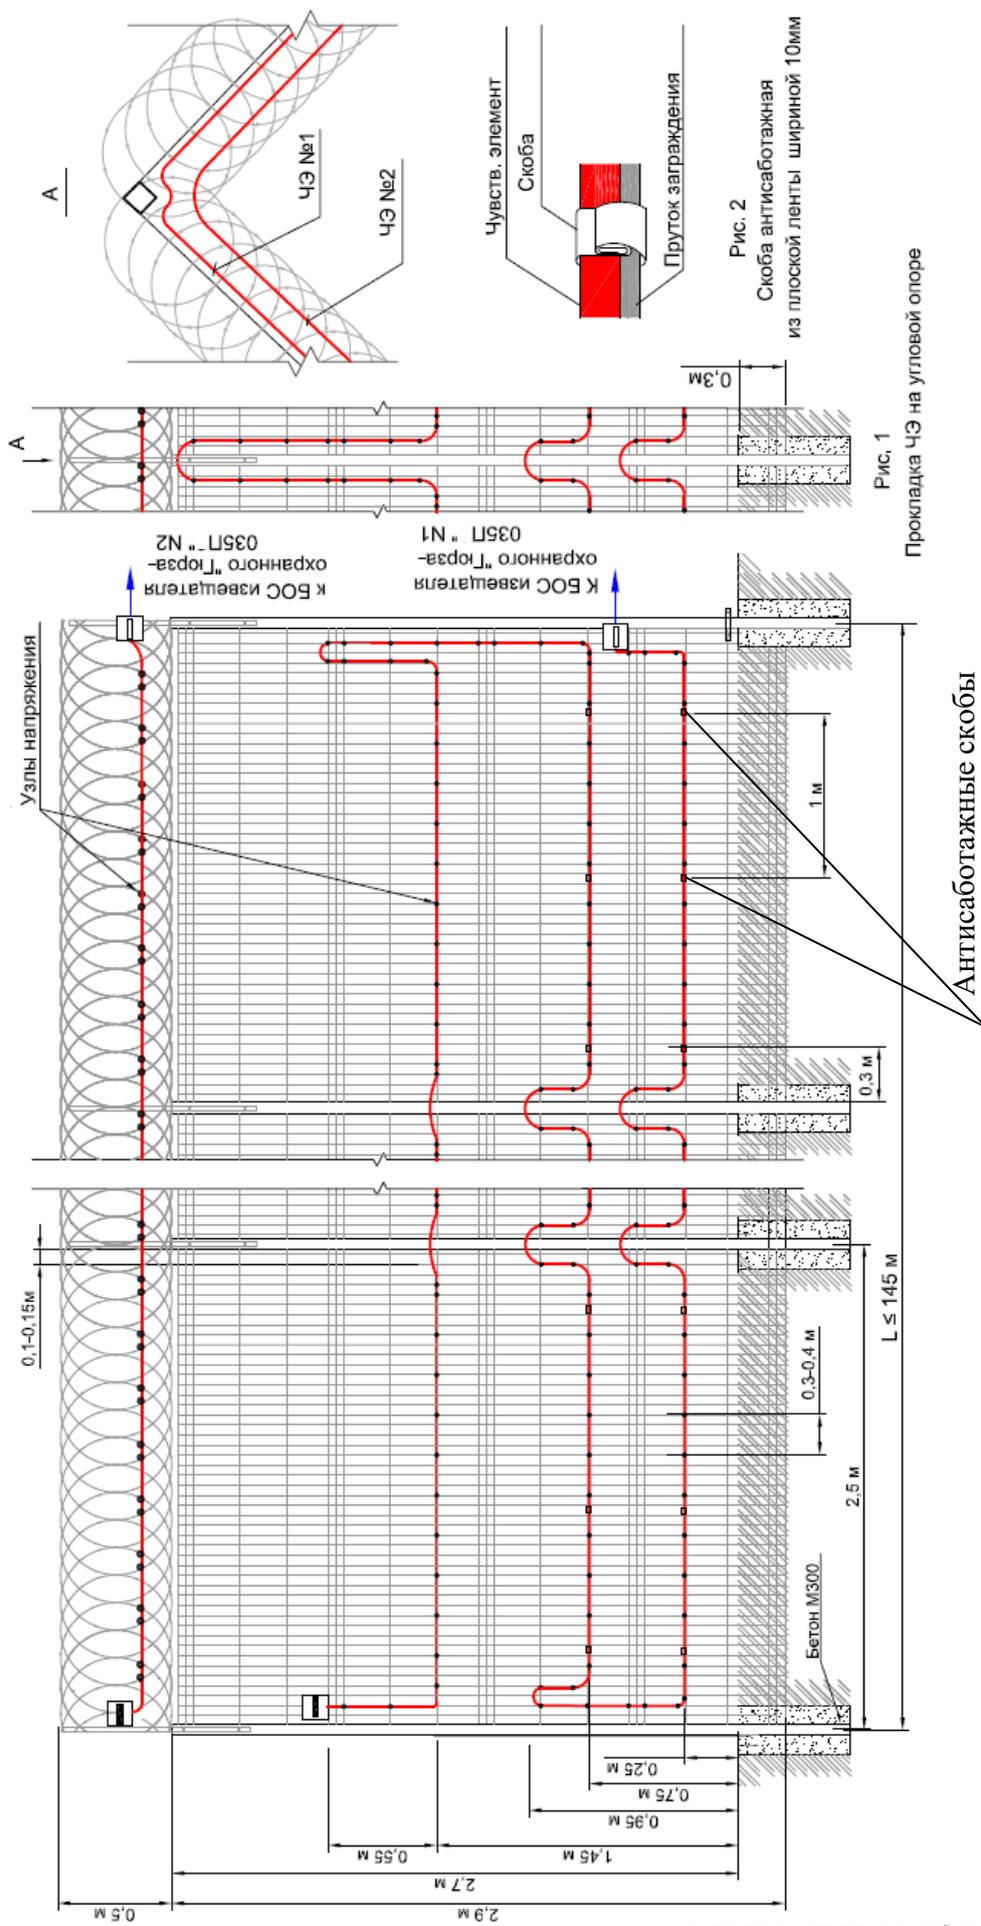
Вариант прокладки ЧЭ на заграждении из сварных решетчатых 3-D панелей с использованием антисаботажных скоб и козырьком из объемной спирали АКЛ
